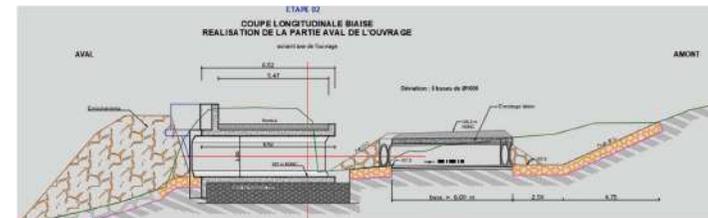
Vue en coupe longitudinale de l'ouvrage en phase travaux (avec déviation)
